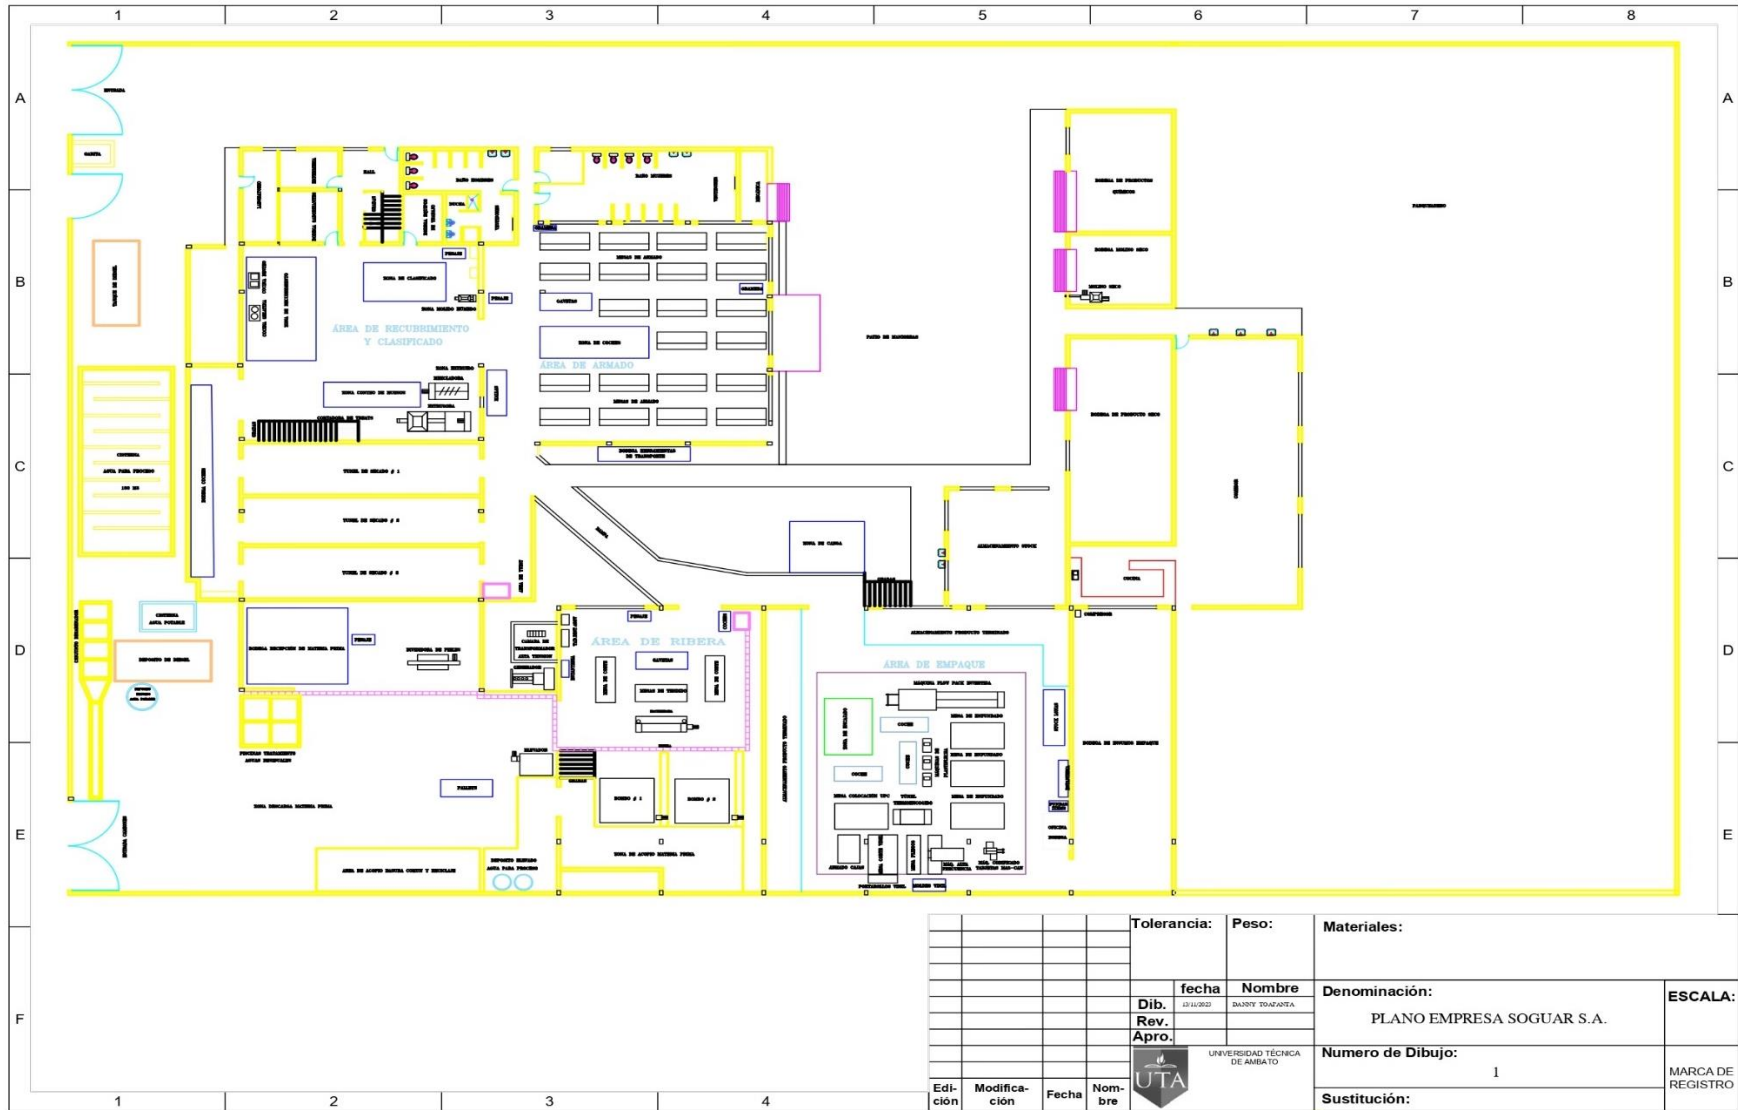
Plano 2D de la planta de producción de la empresa SOGUAR S.A.
